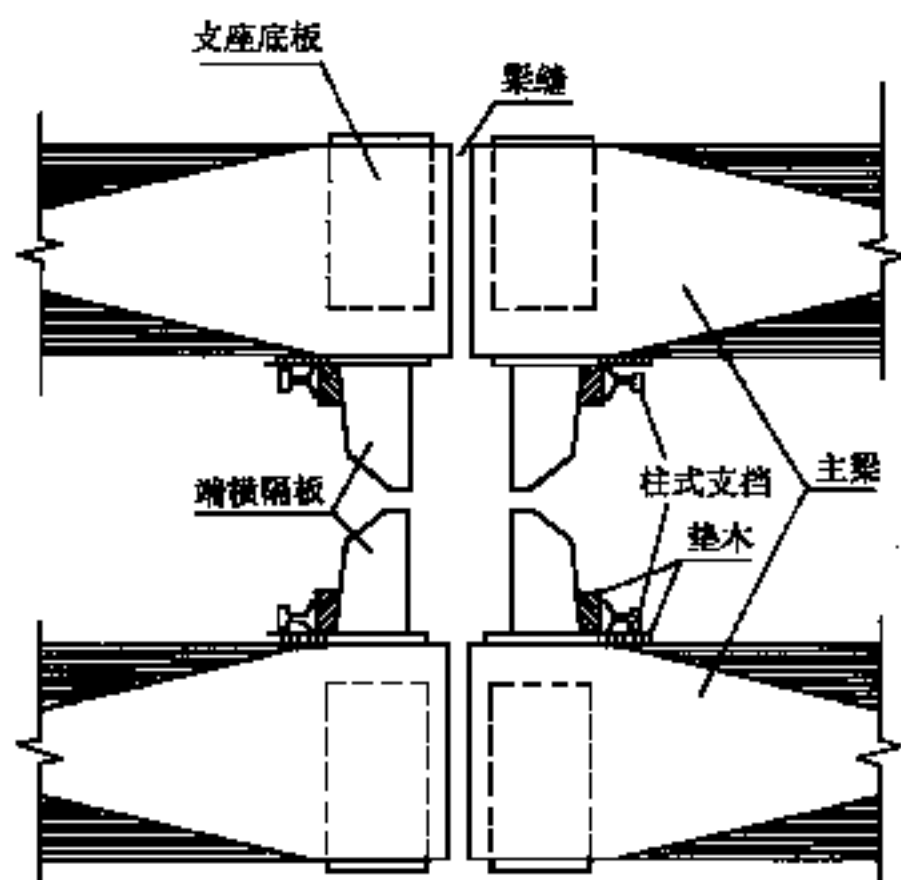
钢筋混凝土梁、预应力混凝土梁纵向支挡布置
